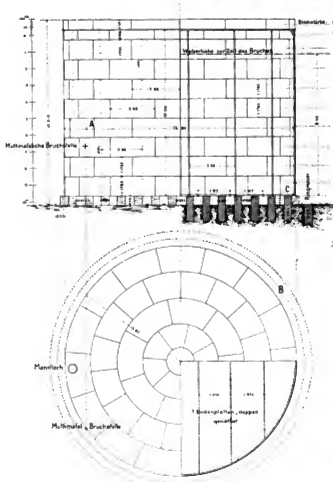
Ansicht und Grundriss des Reservoirs vor dem Zusammenbruch.
